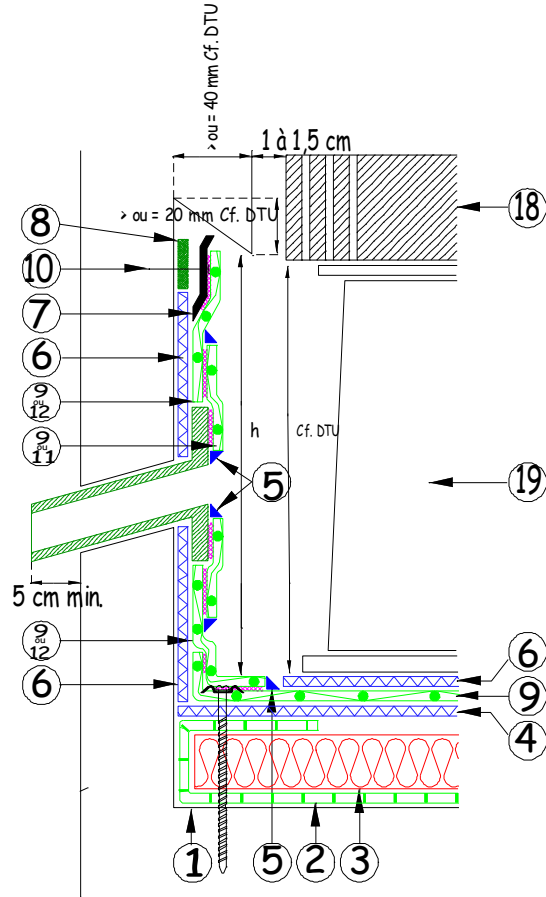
Relevé avec protection lourde par dalle sur plots
